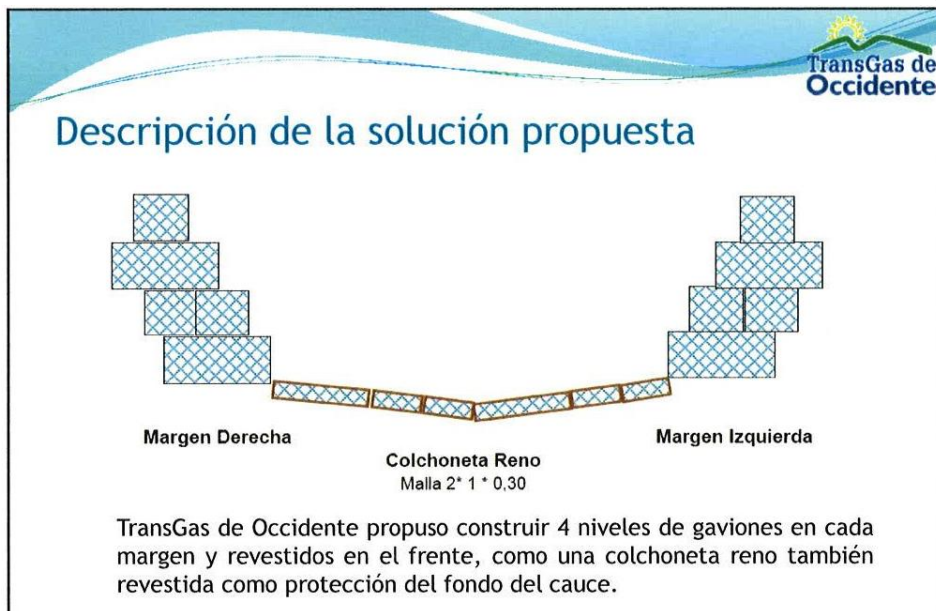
Detalle de las obras de protección, vista de una sección típica.
